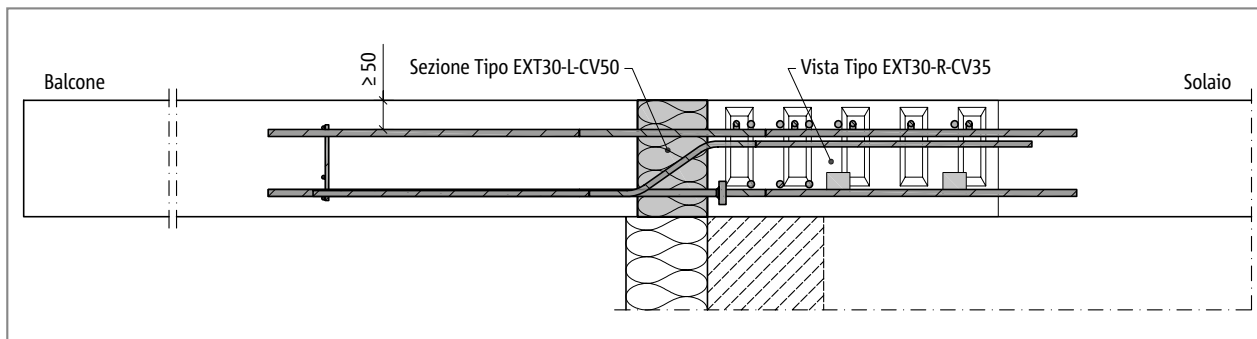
Schöck Isokorb® tipo EXT: angolo esterno con cappotto (vista EXT-L-CV50; sezione EXT-R-CV35)
